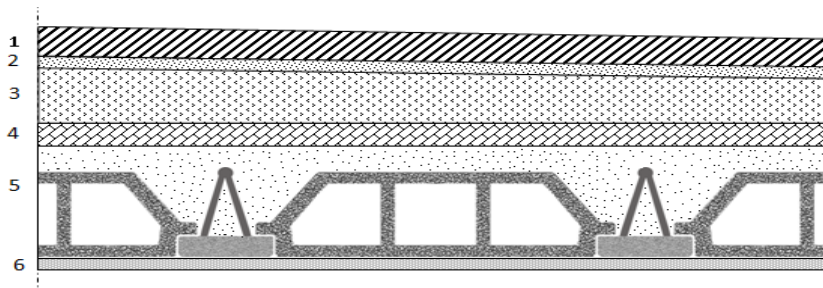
Coupe verticale du plancher terrasse à corps creux.
